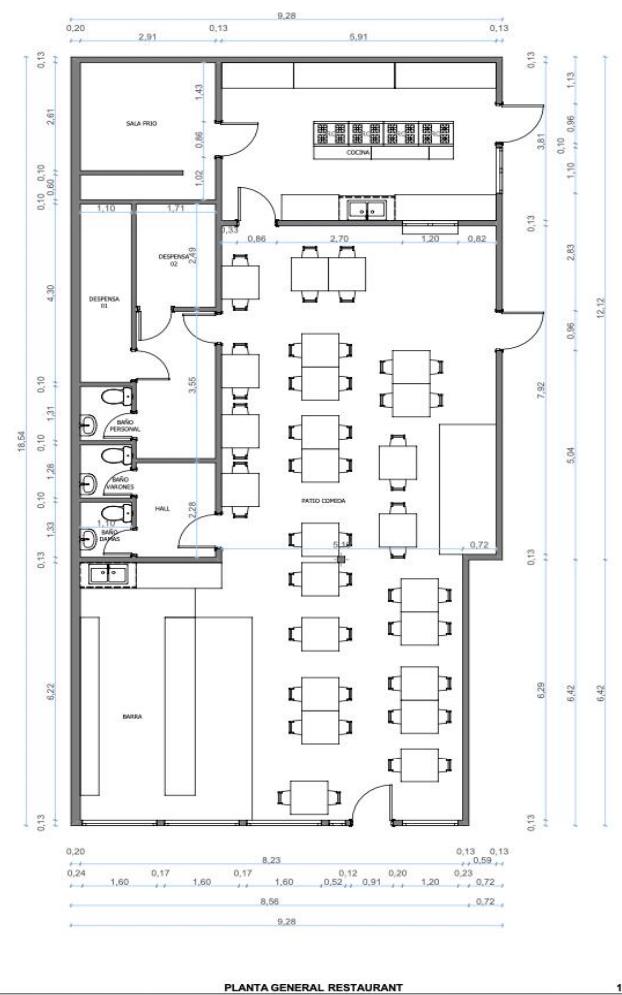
IMAGEN: PLANIMETRÍA CORRESPONDIENTE A SECTOR INTERNO DEL LOCAL
